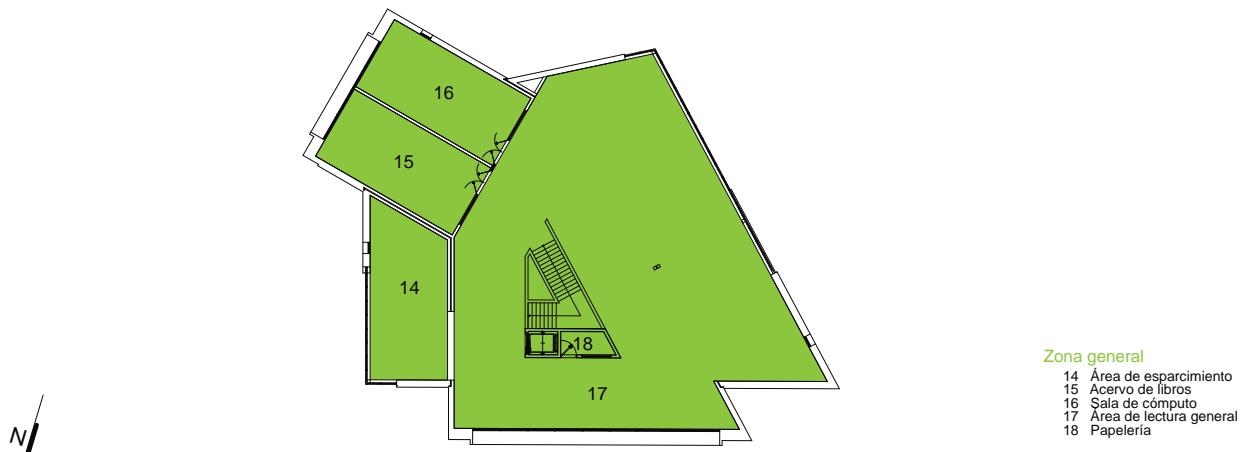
Edificio B. Biblioteca (Segunda planta).
